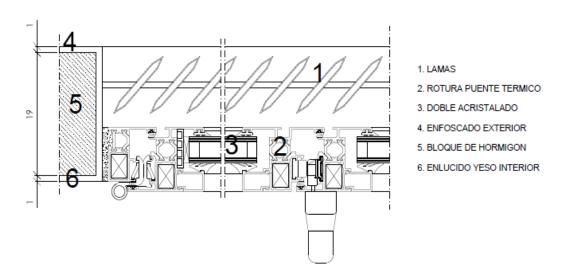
Detalle carpintería metálica huecos de ventanas.
